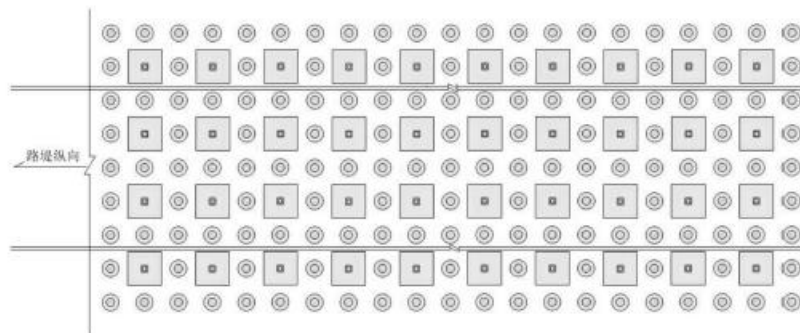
方桩和钉型双向搅拌粉喷桩平面布置示意图
